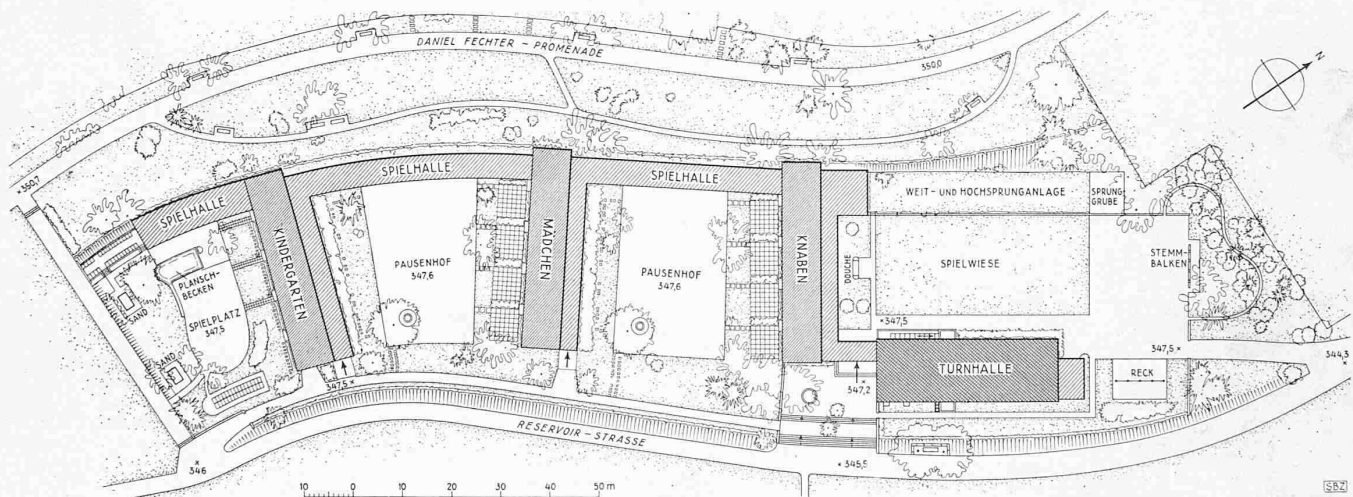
Lageplan der Schulhausanlage mit drei Flügeln zu je vier Klassenzimmern. — Masstab 1 : 1400
